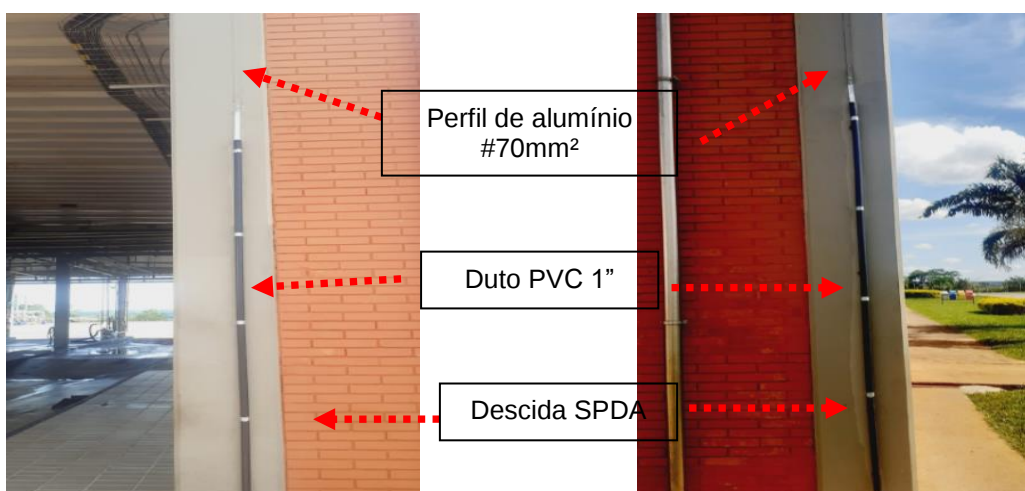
e 76: Interligação de elemento metálico com a malha captora.
